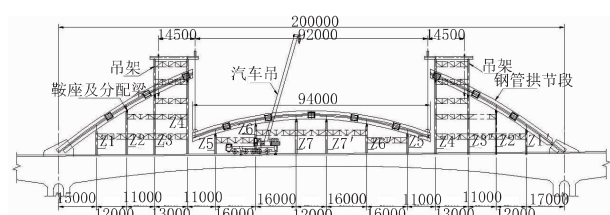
拱肋提升支架施工步骤二布置图(单位:mm)
